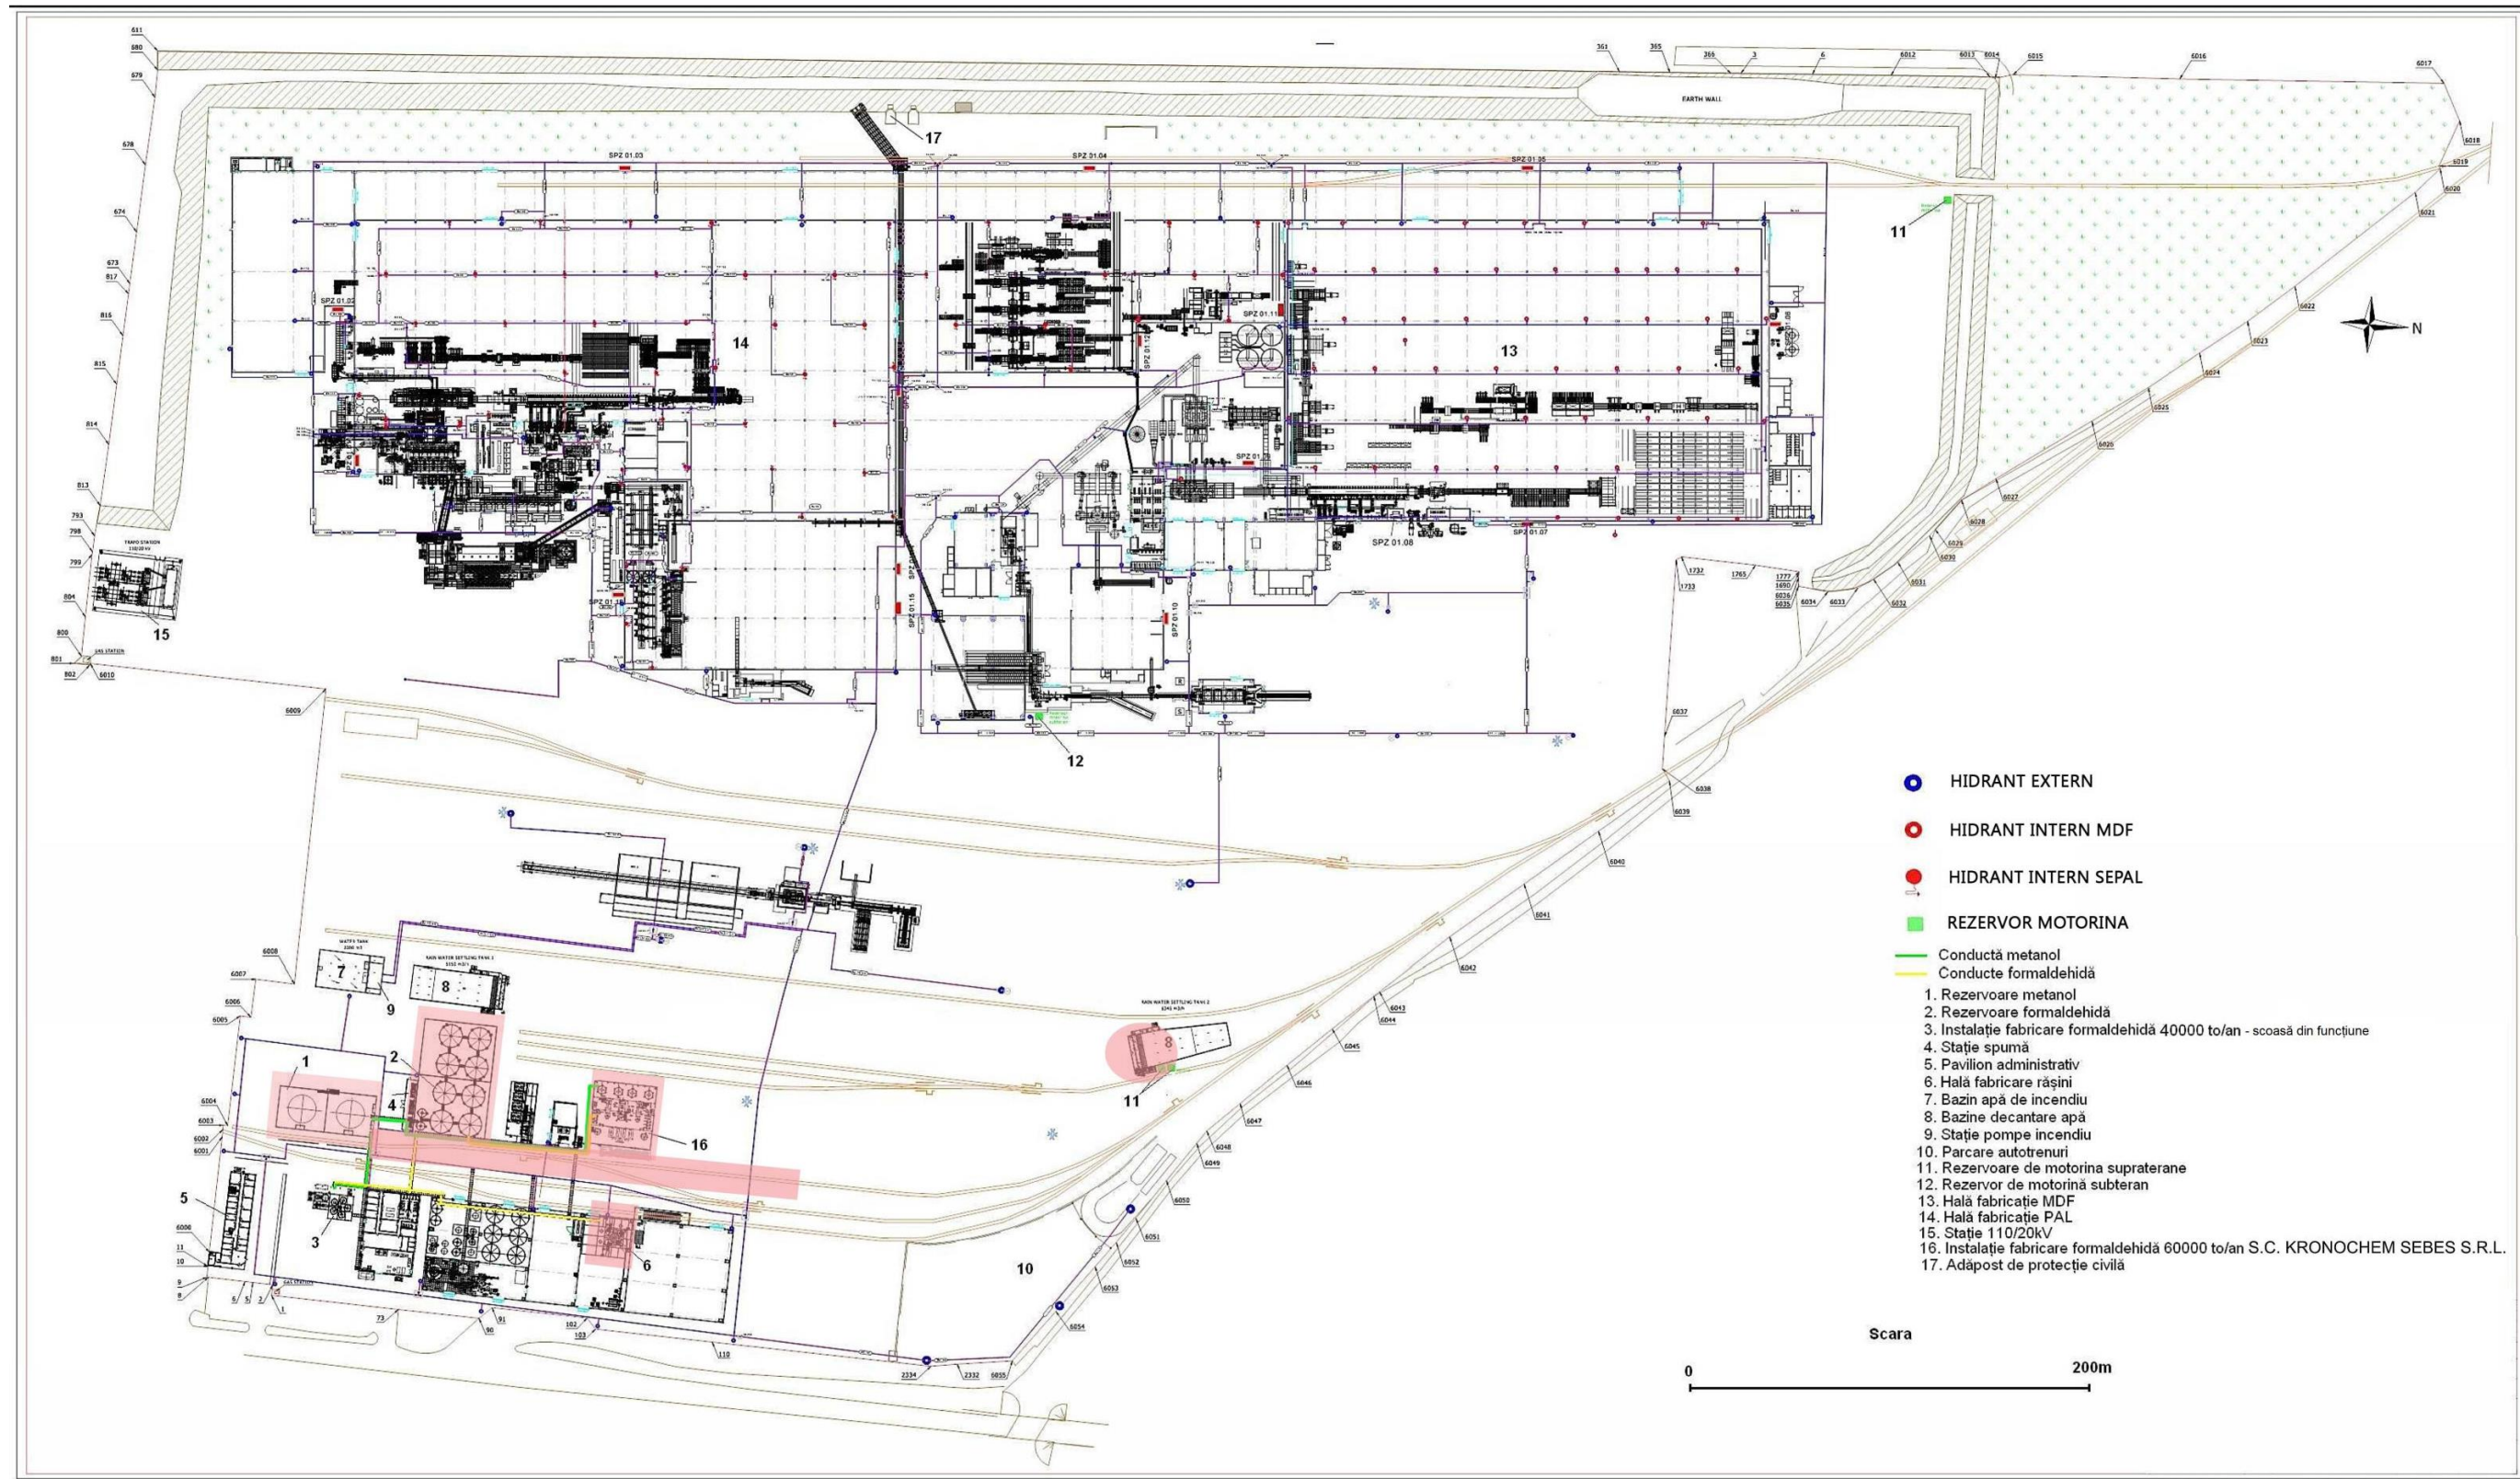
Plan de situtie-Amplasarea instalatiilor de stingere a incendiilor
